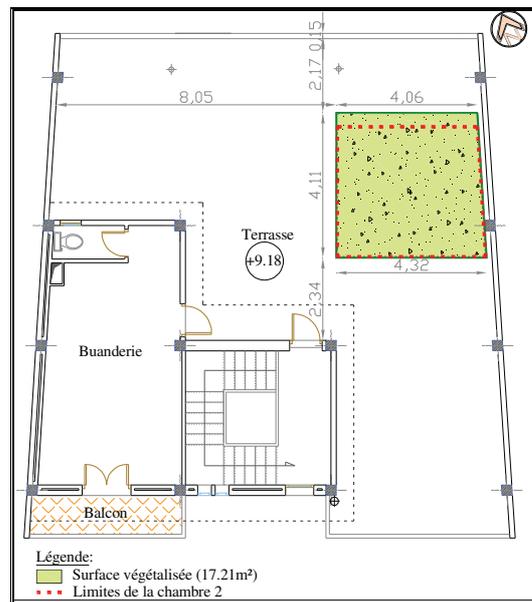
Implantation de la toiture végétale sur la terrasse (ECH : 1/200) (Source. Auteur)
